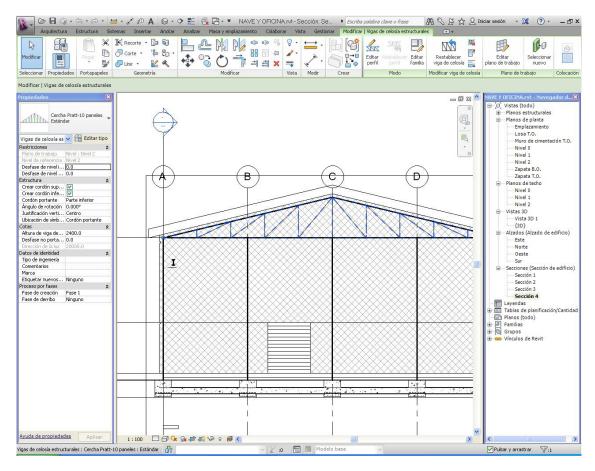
Diseño de estructura metálica de la nave por parte de un equipo de trabajo
